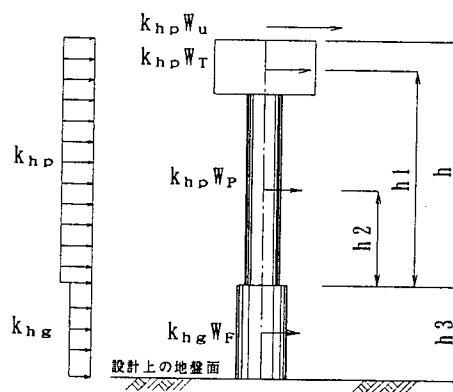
基礎部の安全性の判定において作用させる荷重
